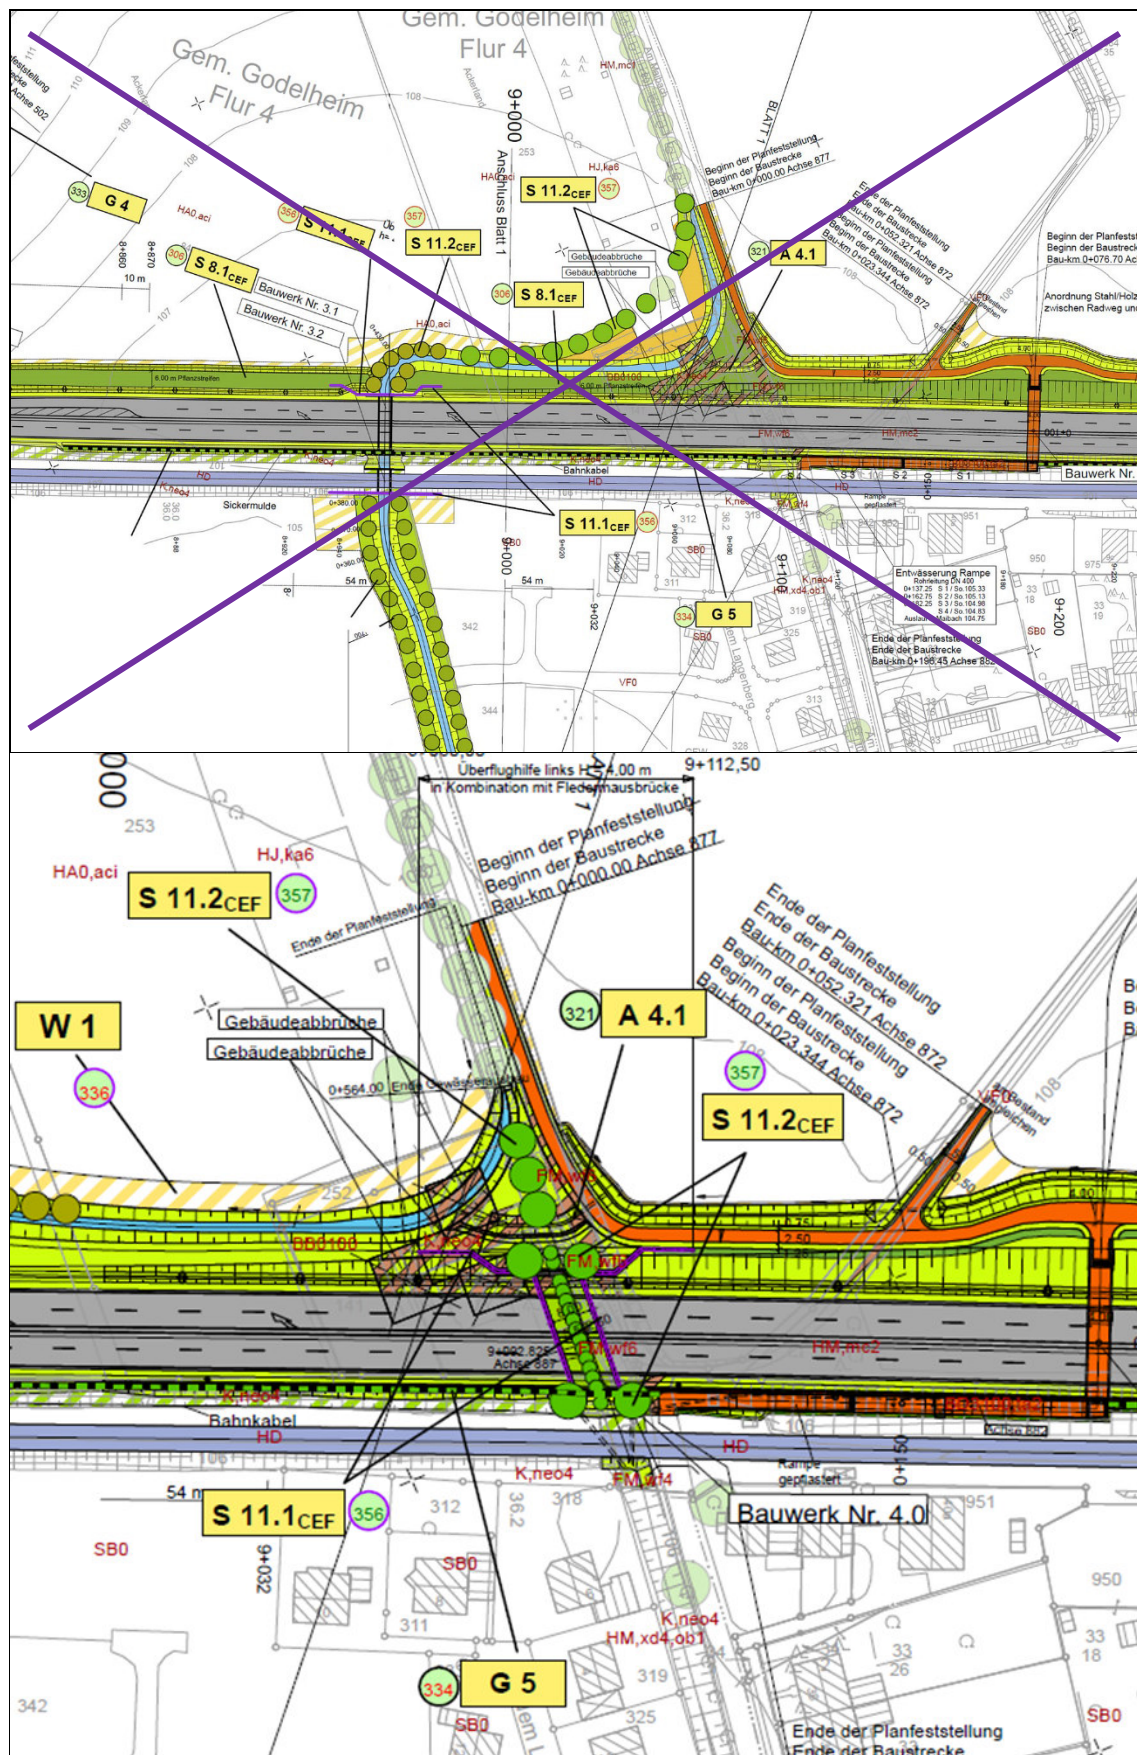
Ausschnitt aus dem Maßnahmenlageplan des LBP zu FR 8 und FR 9, ersetzt durch aktuelle Planung.
